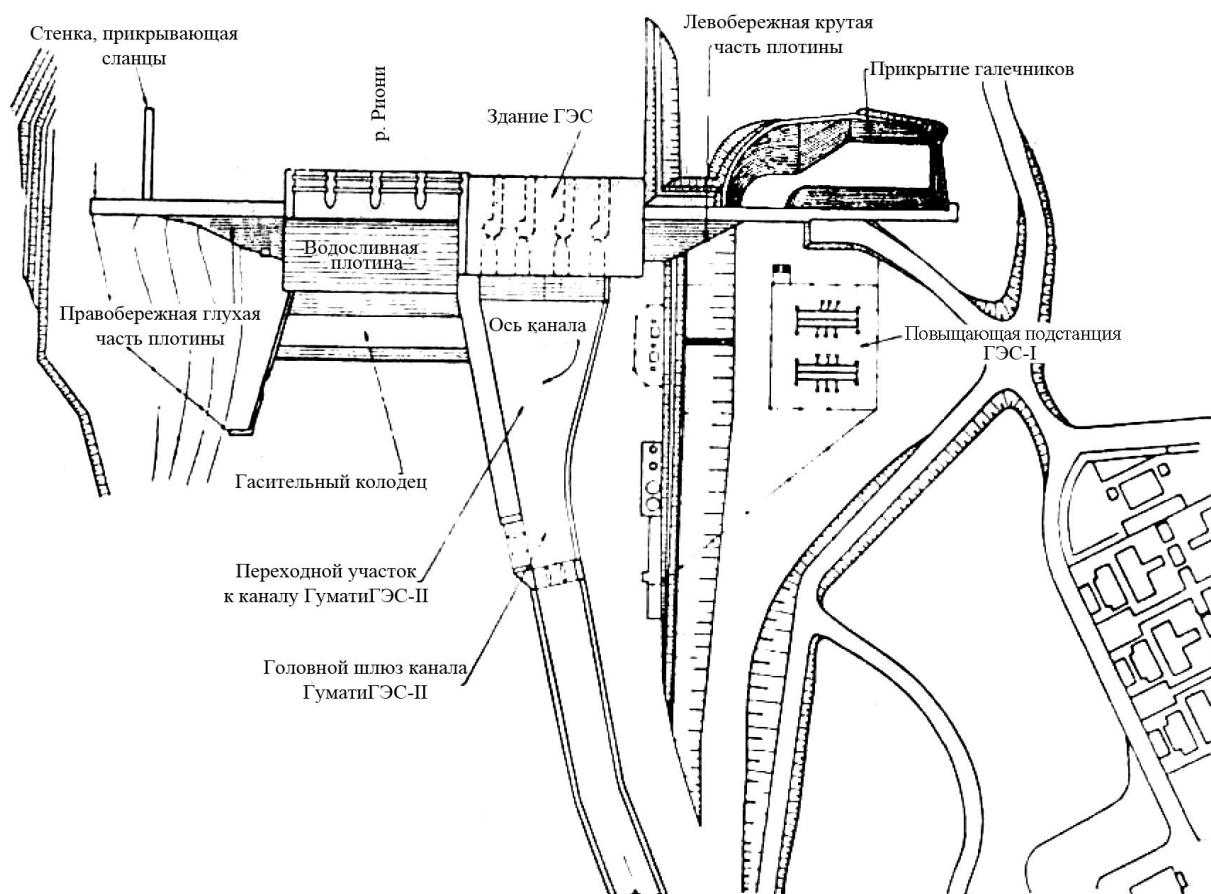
План головного узла Гумати ГЭС-I
